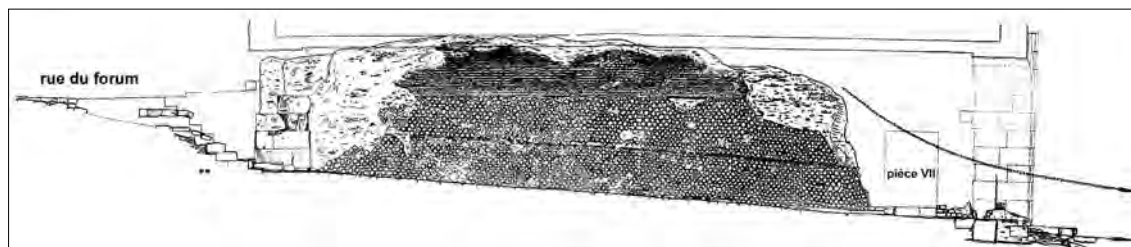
Coupe sur la paroi sud du passage voûté : horizontalité du sommet de la voûte (Hallier *et al.* 1982, fig. 23).
